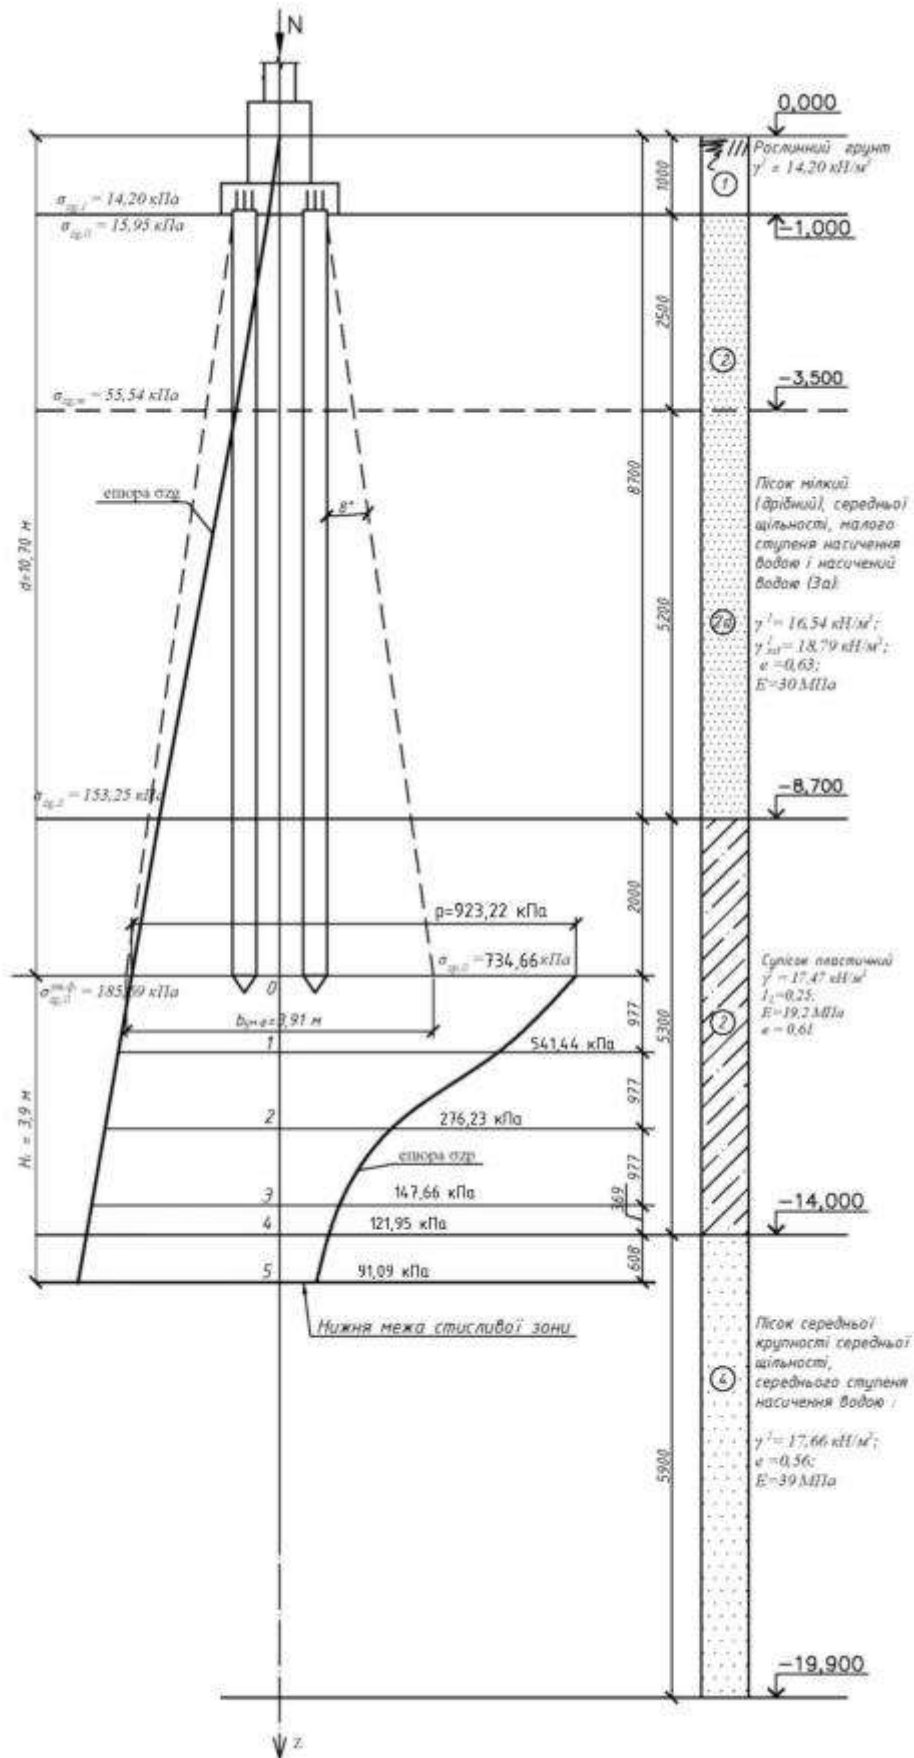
Схема до розрахунку осідання пального фундаменту.
